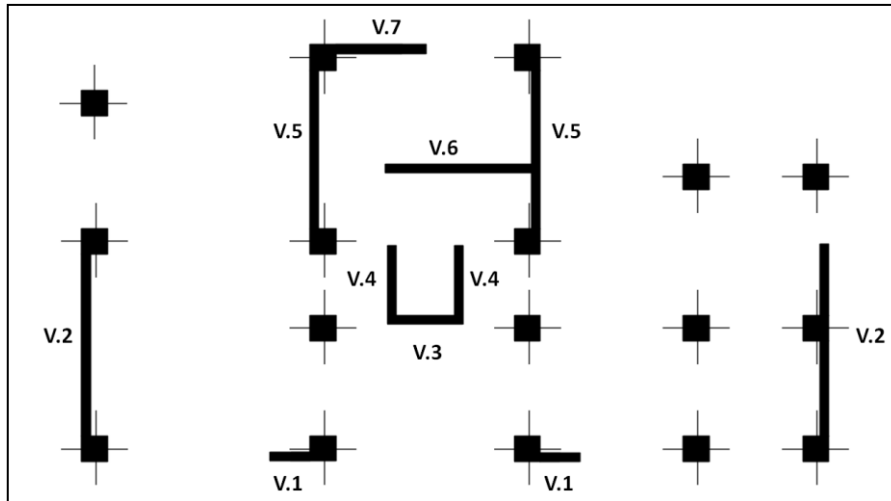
Vue en plan des voile du niveau rez-de-chaussée
